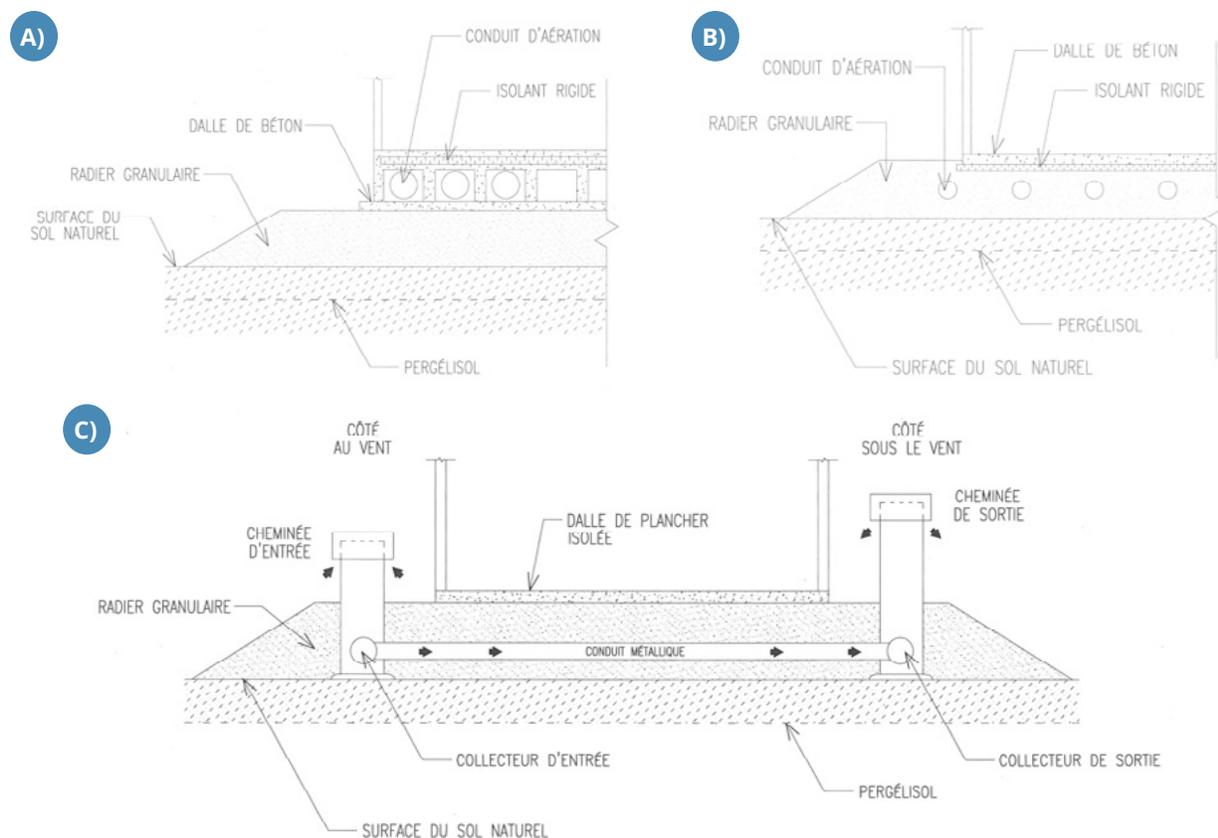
FONDATION VENTILÉE UTILISANT DES CONDUITS DISPOSÉS HORIZONTALEMENT SOUS LA ZONE COUVERTE PAR LA DALLE A) À LA SURFACE OU B) DANS LE REMBLAI. C) FONDATION VENTILÉE AVEC L'AJOUT DE CHEMINÉES AFIN D'ACCROÎTRE LA CIRCULATION D'AIR DANS LE SYSTÈME PAR LE PHÉNOMÈNE DE TIRAGE THERMIQUE (MODIFIÉ DE JOHNSTON, 1981).
